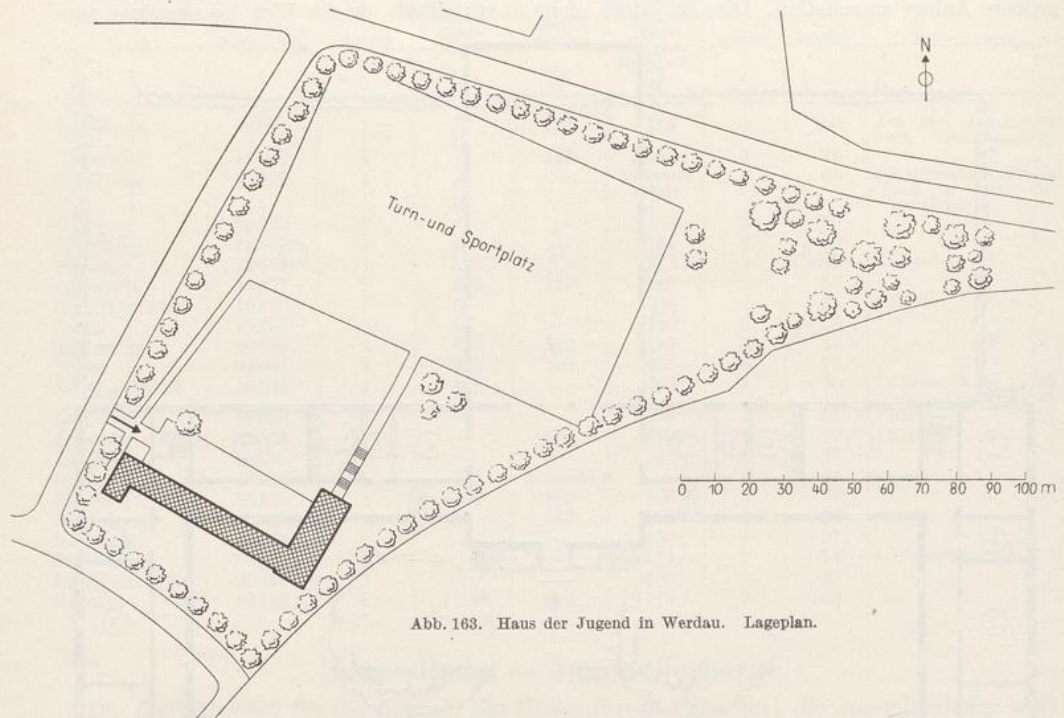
Haus der Jugend in Werdau. Lageplan.
